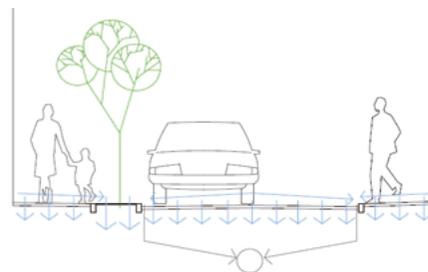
Esquema de pavimento con dren permeable y otros elementos de infiltración.
